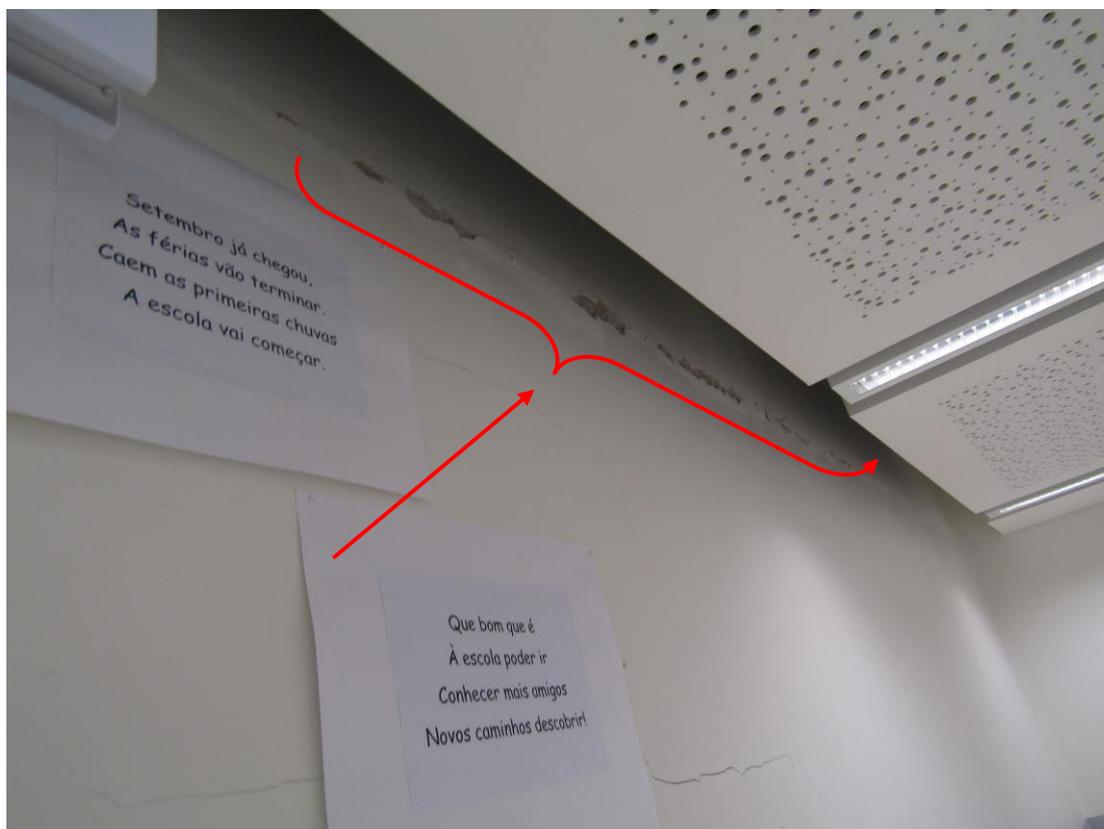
FISSURAS (SAULA AULA) LIGAÇÃO ALVENARIA /PORTICO
